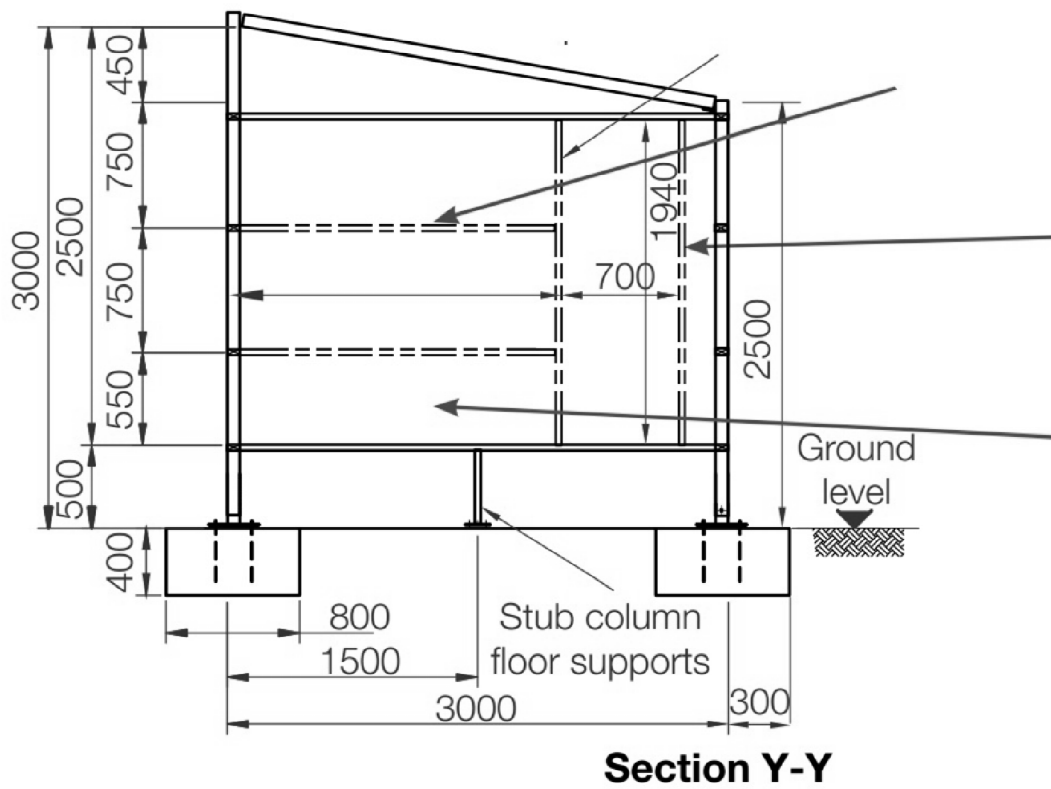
Desenho técnico do abrigo, corte construtivo.
